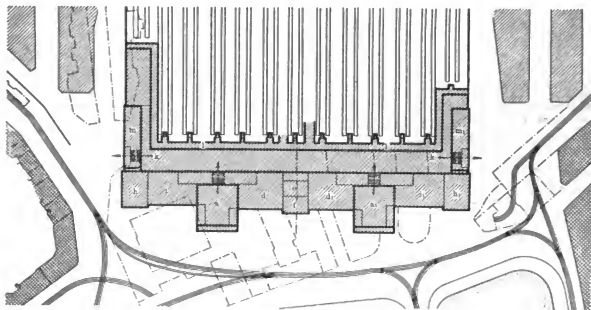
Grundriß des Leipziger Hauptbahnhofs.
